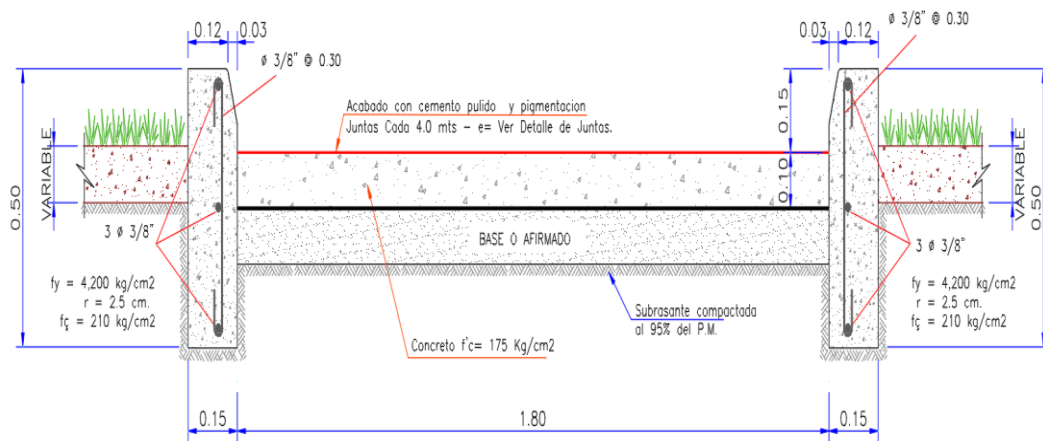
Secciones Transversal de Vereda en Viviendas
